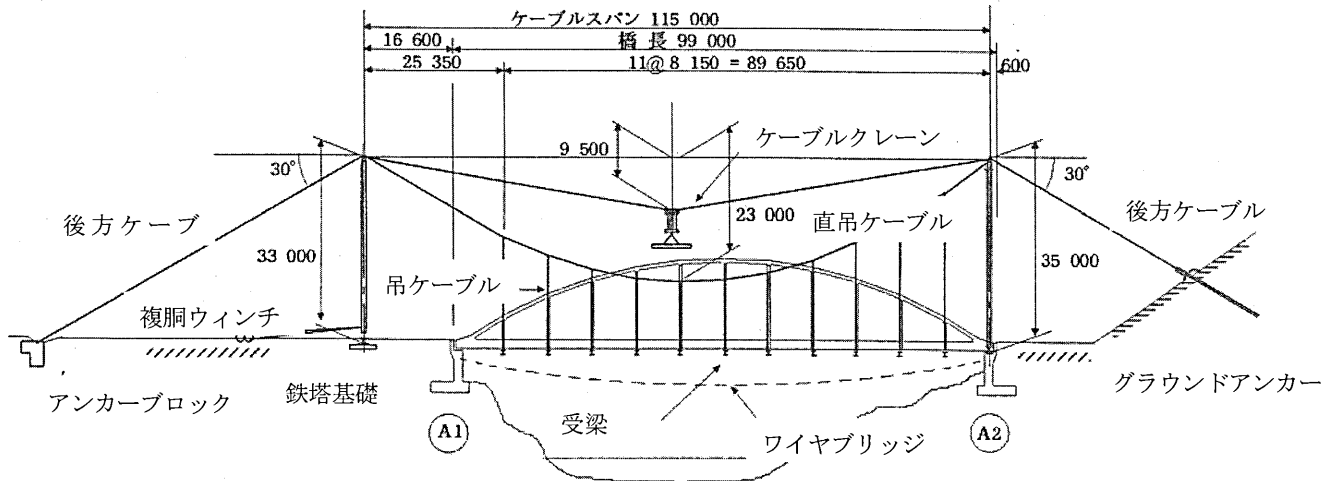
直吊り工法によるアーチ橋の架設 (寸法単位:mm)
